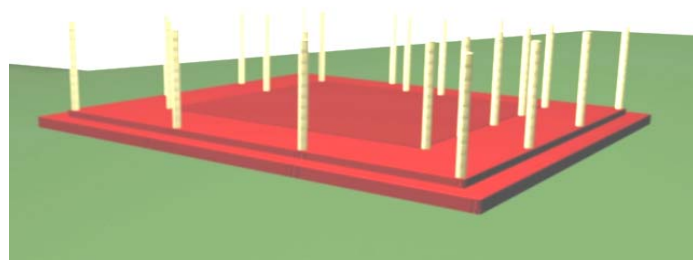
Sistema construtivo, 2º passo: colocação dos pilares e previsão das instalações.
